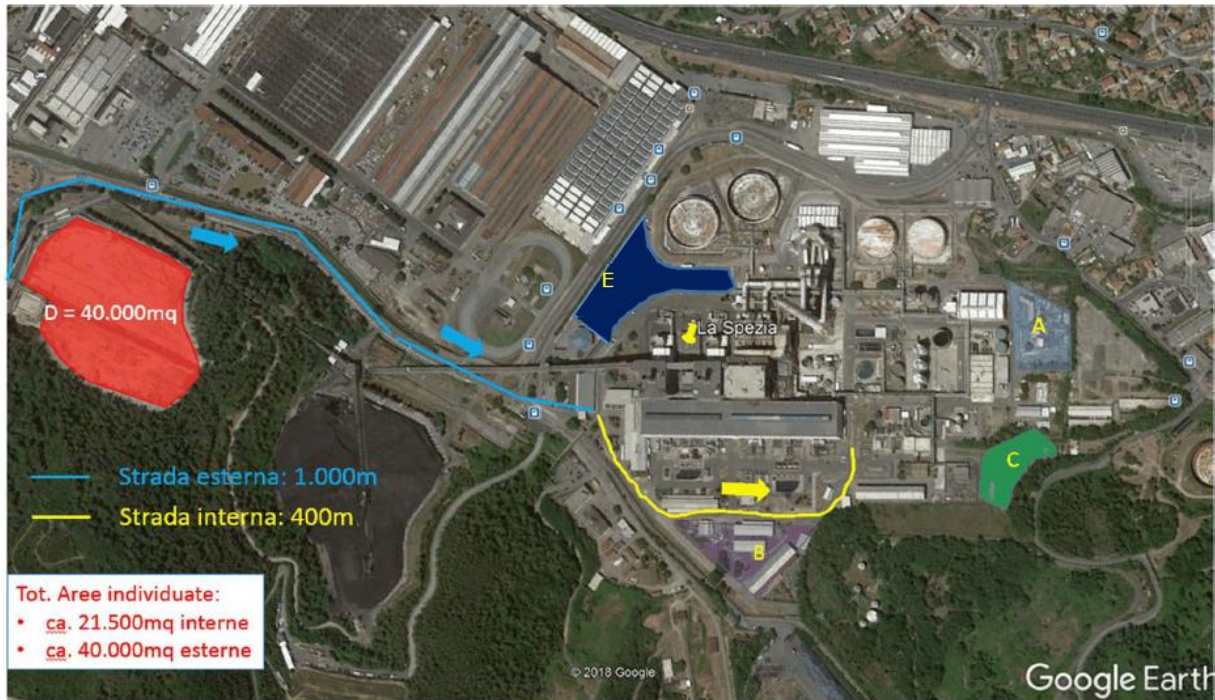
Rappresentazione delle aree di cantiere aggiuntive alla centrale
